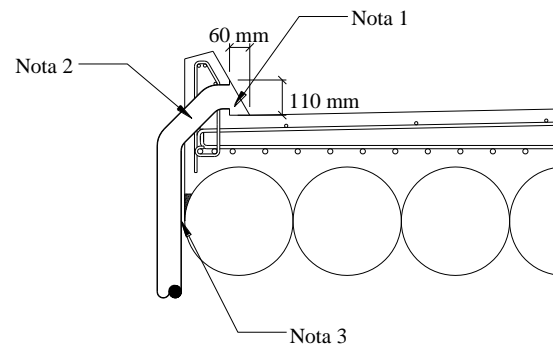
Secção transversal do dispositivo de drenagem.
